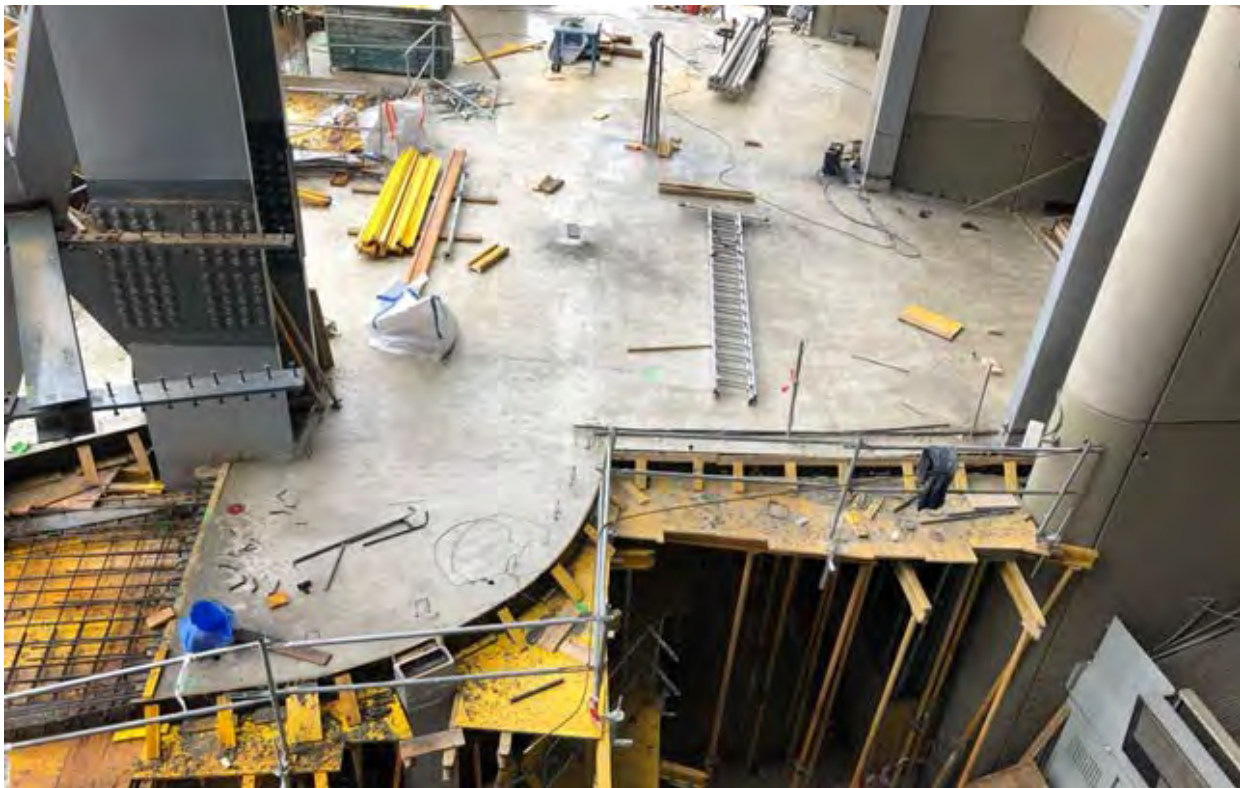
Geometría de la planta tipo. Foto cedida por cortesía de 'Nuevo Estadio Bernabéu' - Copyright © 2024 Nuevo Estadio Bernabéu.
